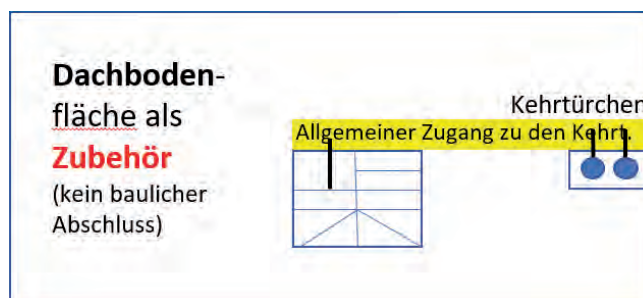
Rohdachboden mit Zugangsweg zu den Kehrtürchen, Dachbodenflächen als Zubehör
